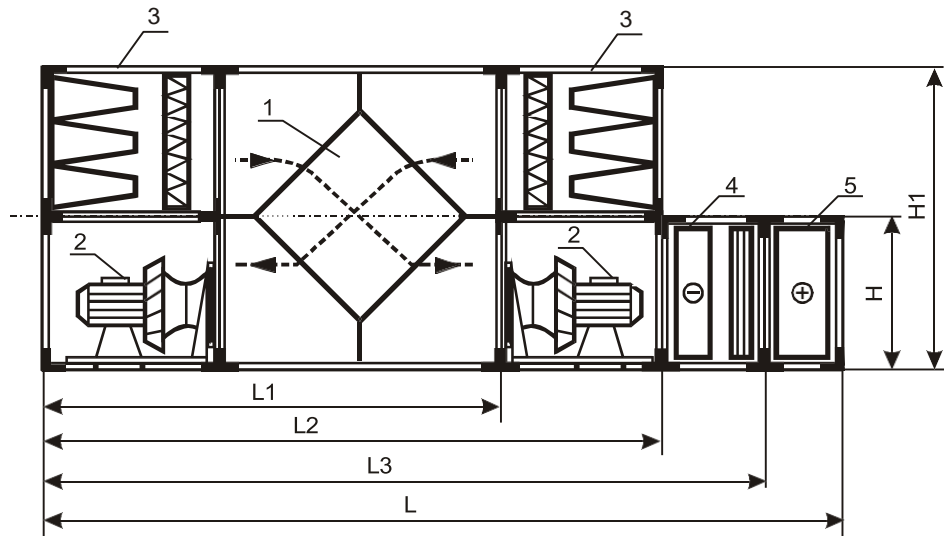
Конструктивна схема припливно-витяжного агрегату з пластинчастим рекуператором:
